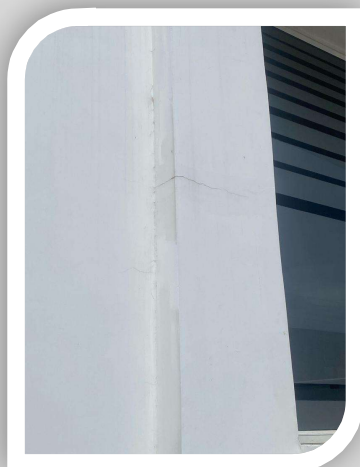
Fisura en pie de puerta lesión 2
